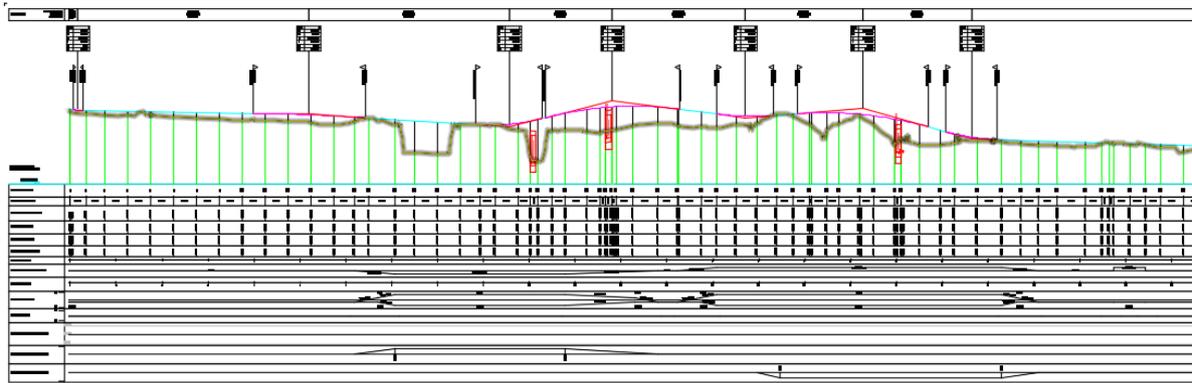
Stralcio profilo longitudinale asse principale del progetto definitivo
